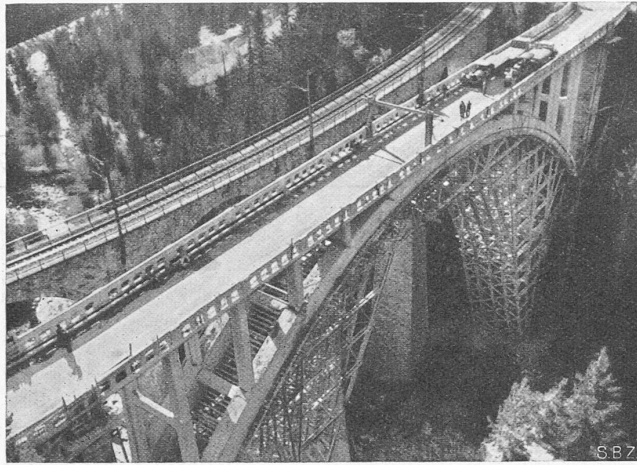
Fertige Brücke mit dem Lehrgerüst
